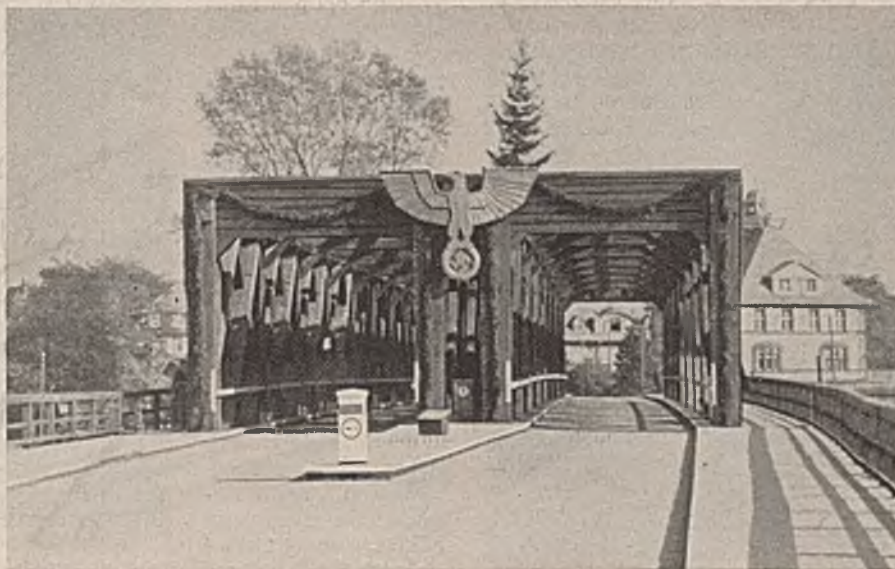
Blick auf die Endrahmen der fertigen verschalteten 50-m-Fachwerkbrücke.
